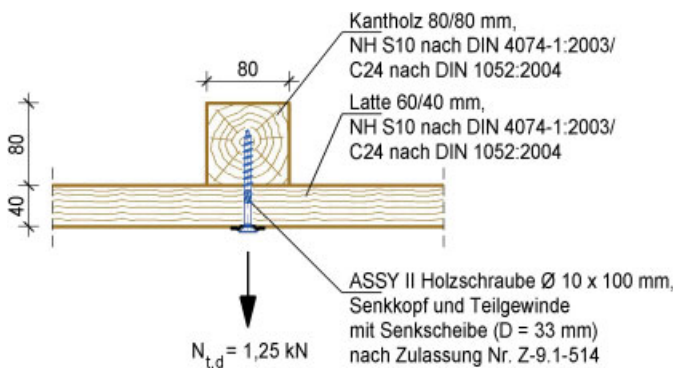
Ausführung mit selbstbohrender Schraube und Unterlegscheibe
